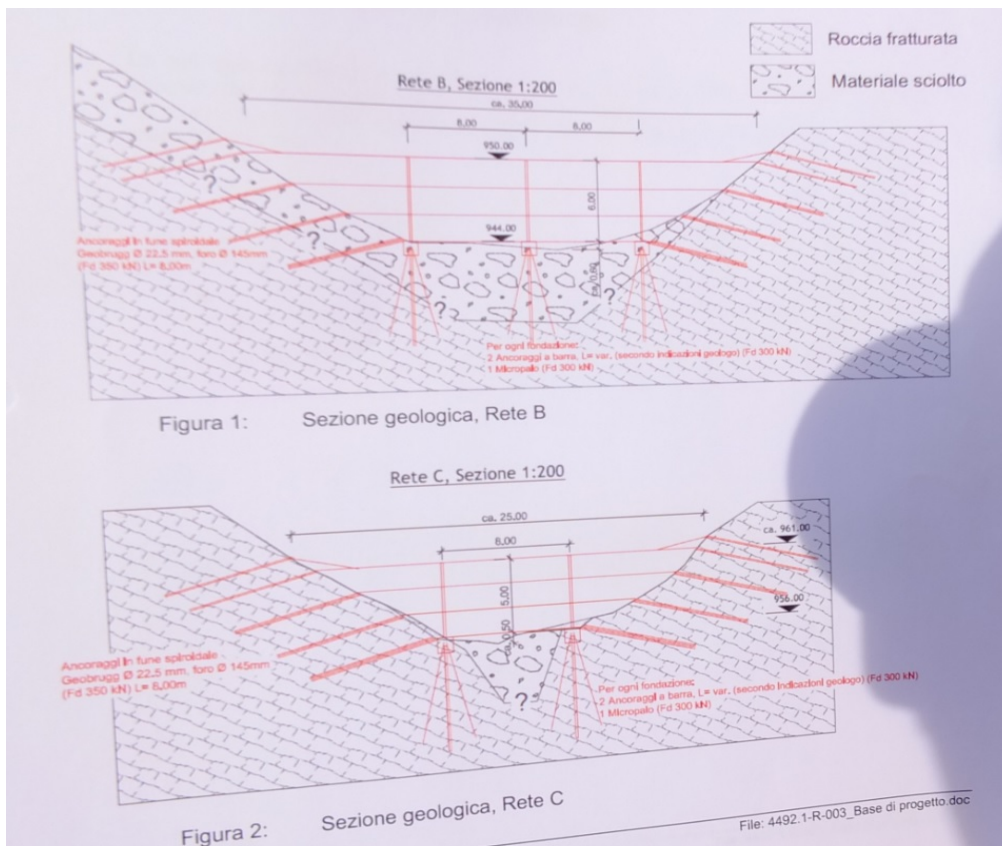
Bilde er tatt fra en rapport som viser dimensjoneringsgrunnlaget for gjerdene (Foto: Gunne Håland)
